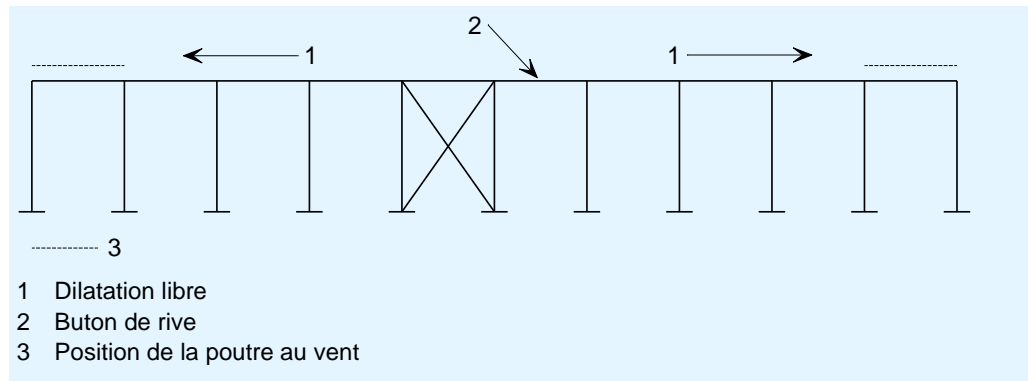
Contreventement typique en croix au centre de la structure pour autoriser la libre dilatation
